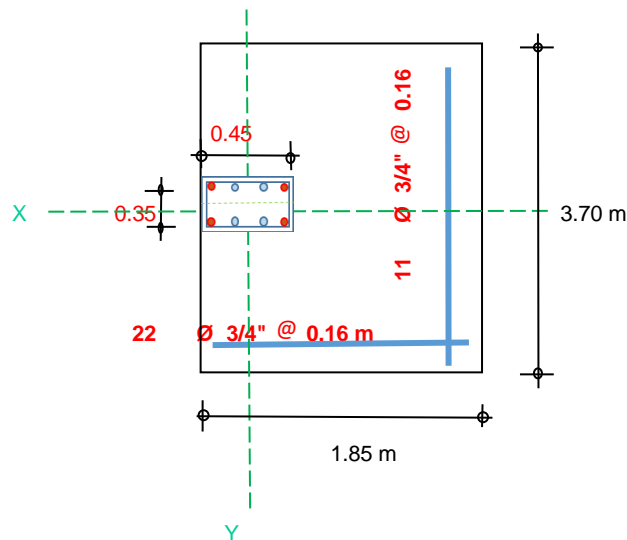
Detalle de planta de zapata excéntrica (Estructura 1).
